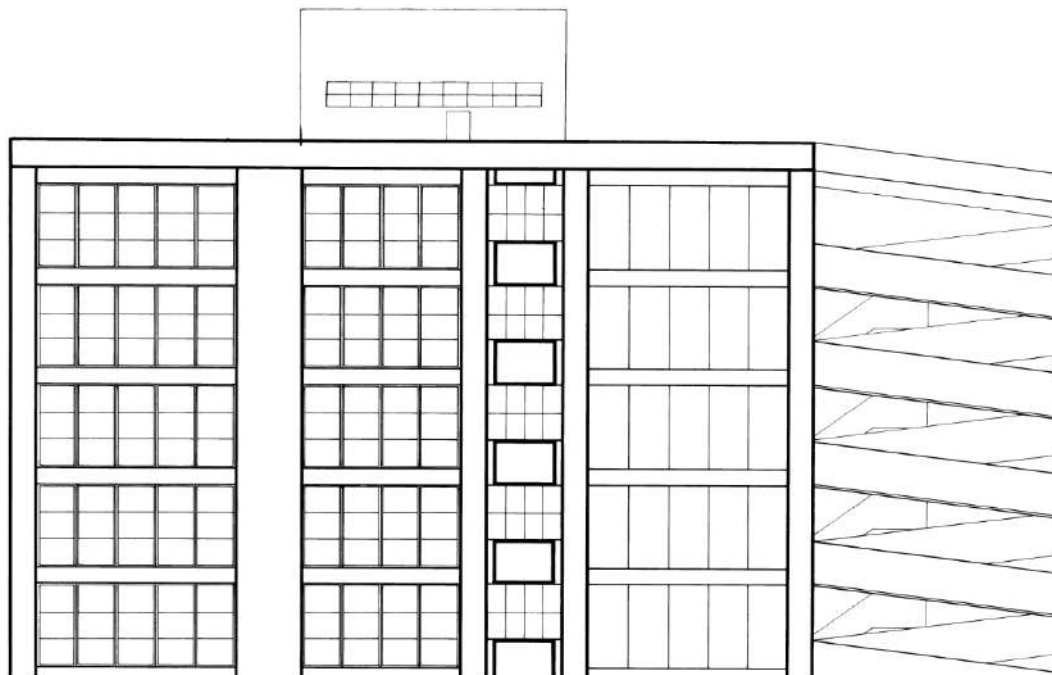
UERJ. Conjunto Escolar, Fachada Lateral. Projeto definitivo. Ampliação de trecho.
